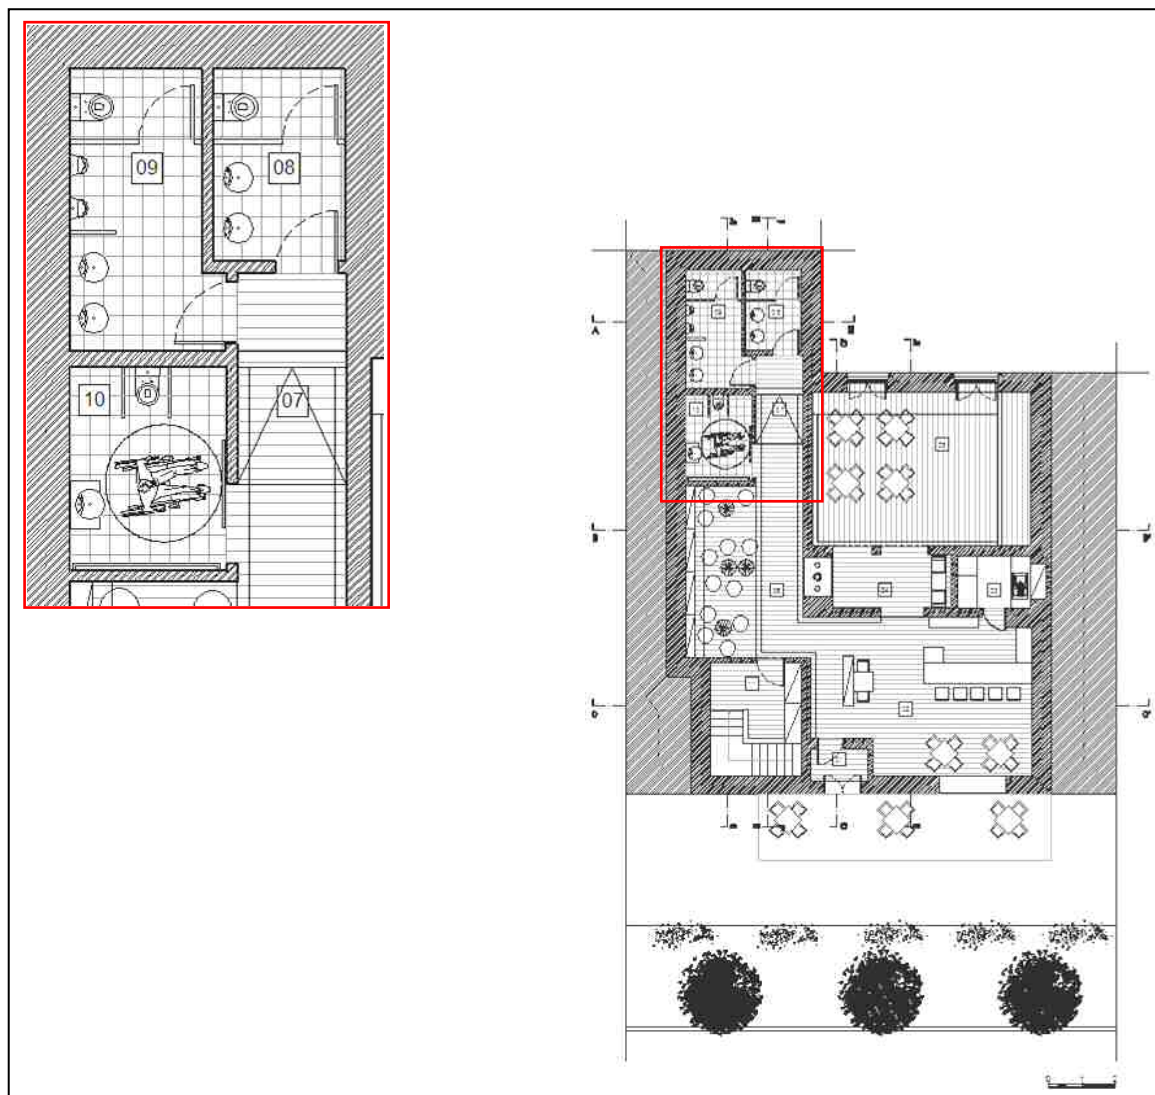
Zona das instalações sanitárias, Planta Piso 0.
